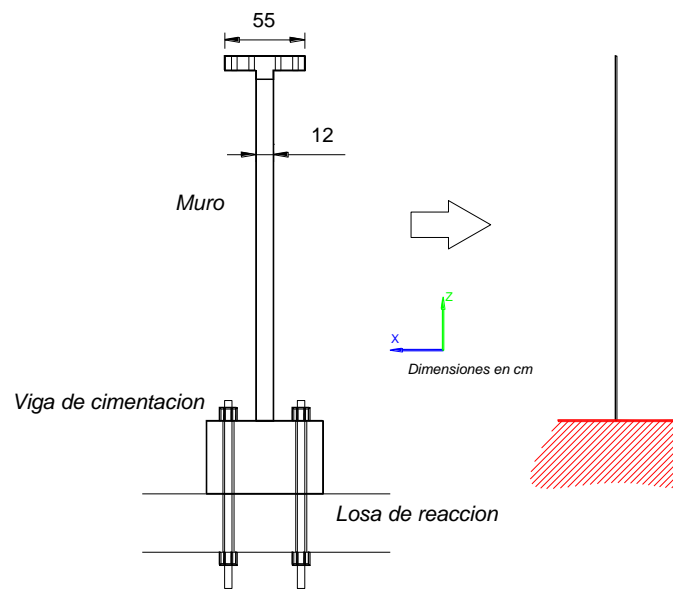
Corte del muro con la losa de reacción y cimentación, se contempla igual a un empotramiento.
